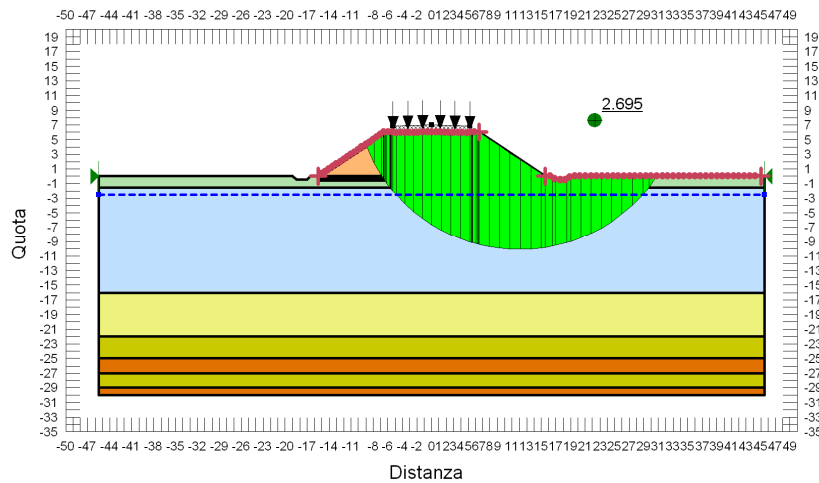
VERIFICA DI STABILITÀ GLOBALE RILEVATO DI H=6.00 M - CONDIZIONE STATICA NON DRENATA.
